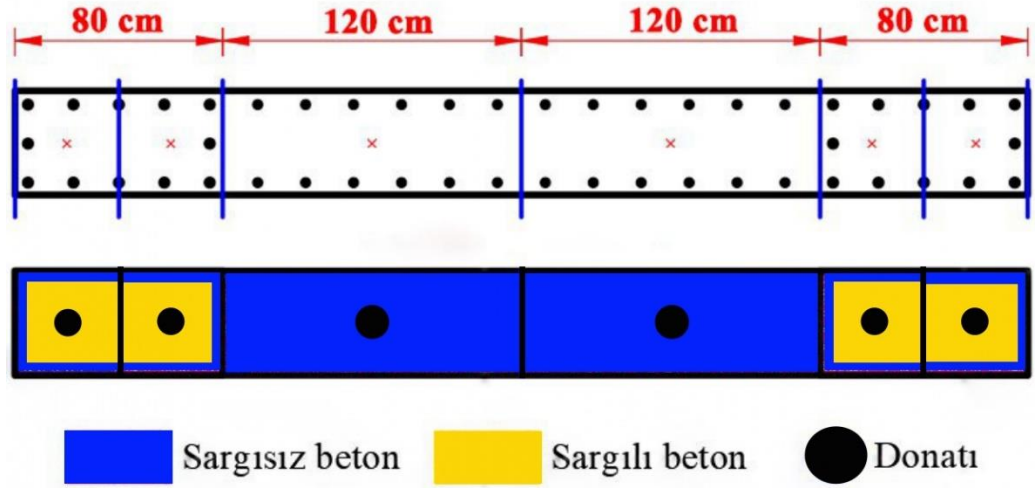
SAP2002'de 10 katlı yapı için kolon kesitinin oluşturulması
